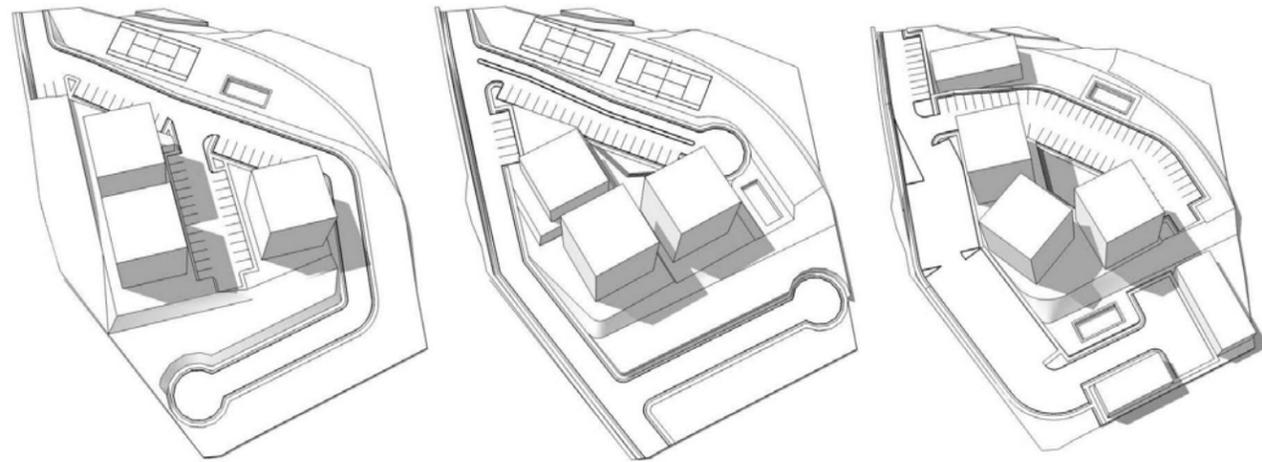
Modelos en 3D de Conjuntos Arquitectónicos
